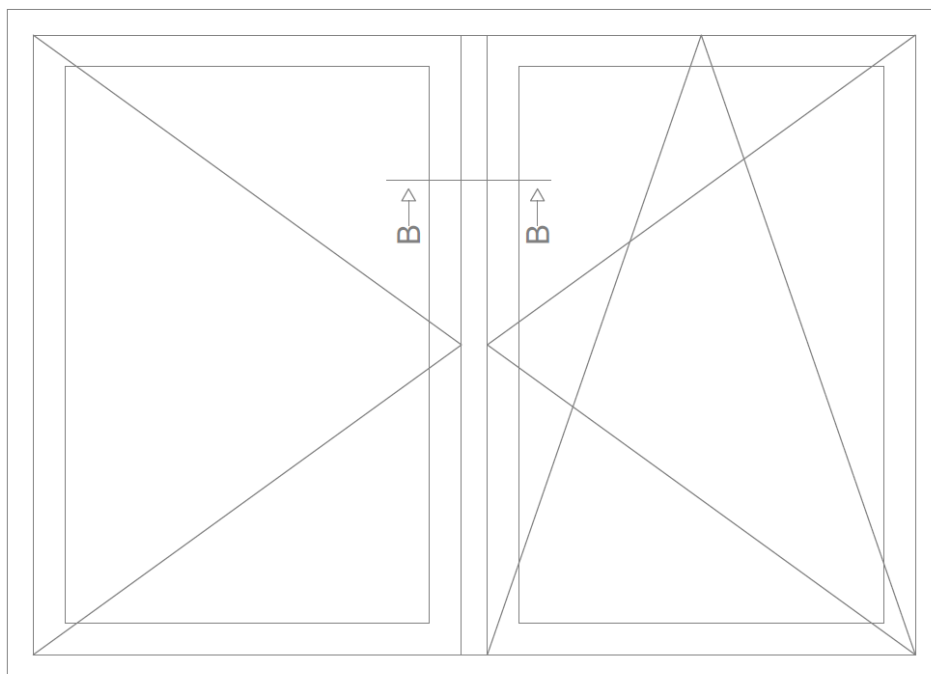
Vista de um caixilho de duas folhas de batente - corte B-B.
